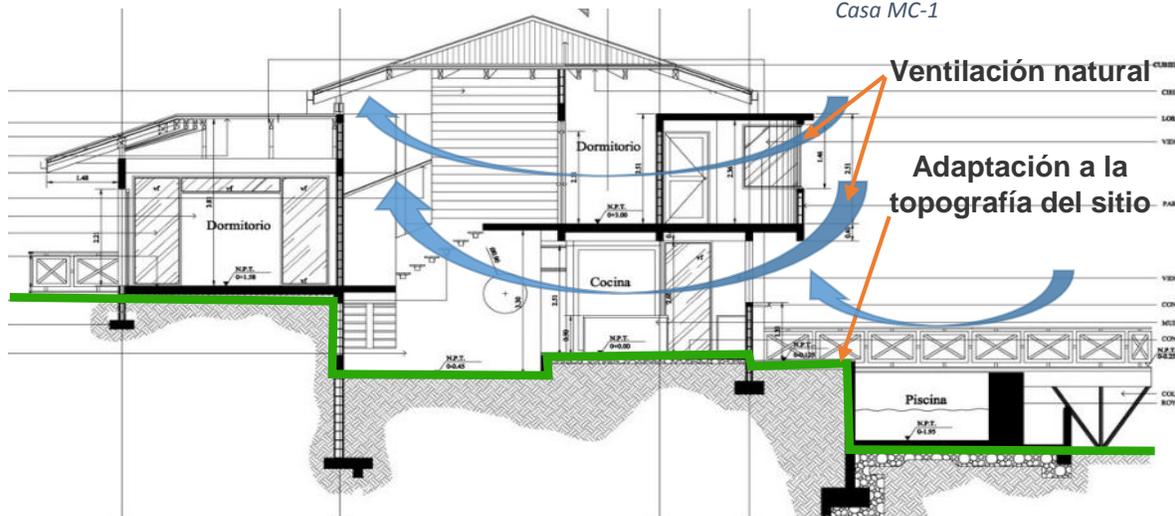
Sección arquitectónica Transversal Casa MC-1
